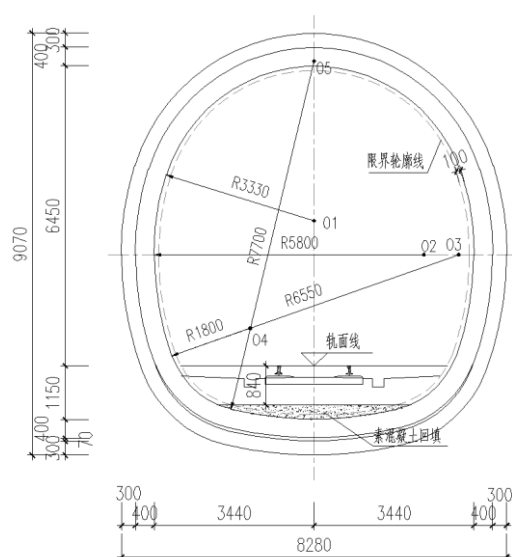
区间隧道浅埋暗挖断面（单位：mm）
